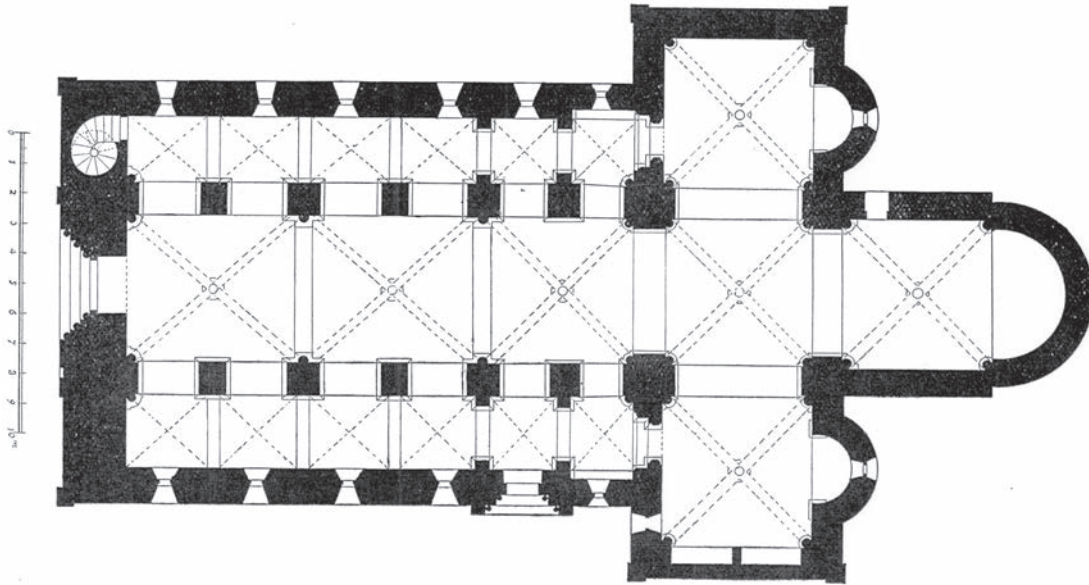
Wölchingen, Johanniterkirche, Grundriss (Reproduktion nach Oechelhäuser)
